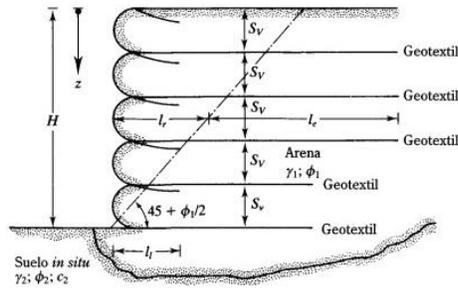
Muro de contención con refuerzo geotextil. (Das, 1999).
